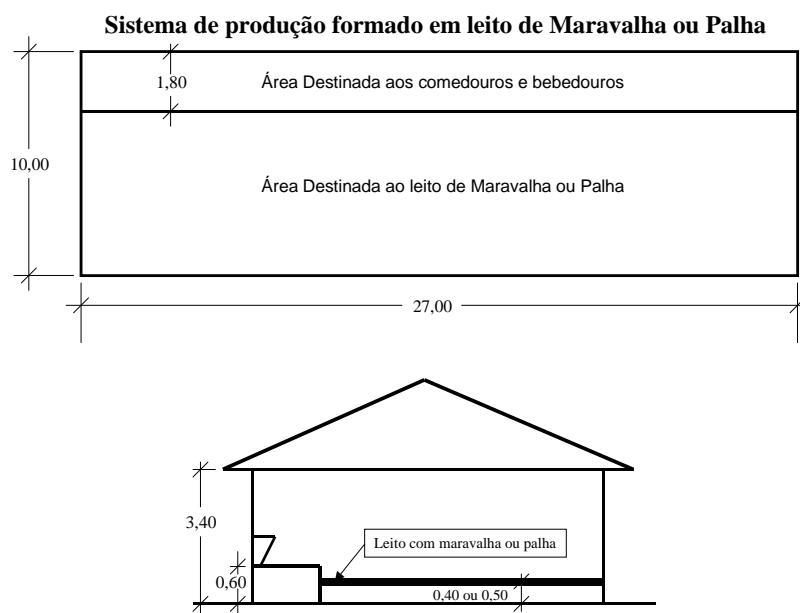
Planta baixa e corte da edificação para a produção de suínos em leito formado por maravalha, unidade de medida (m).
